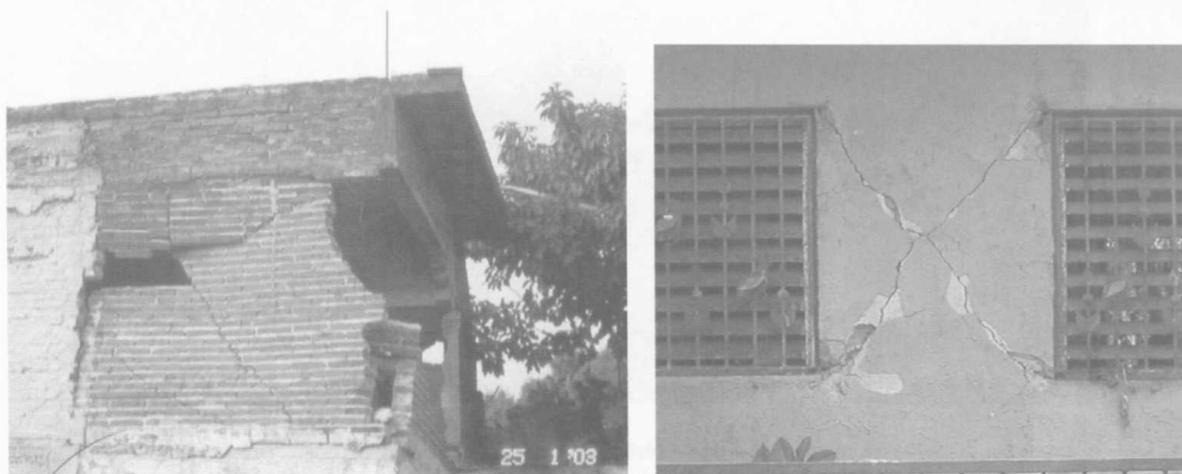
a) Daño en muro de mampostería simple; b) Agrietamiento en "X" en un segmento de muro entre ventanas, Villa de Álvarez, Col.
